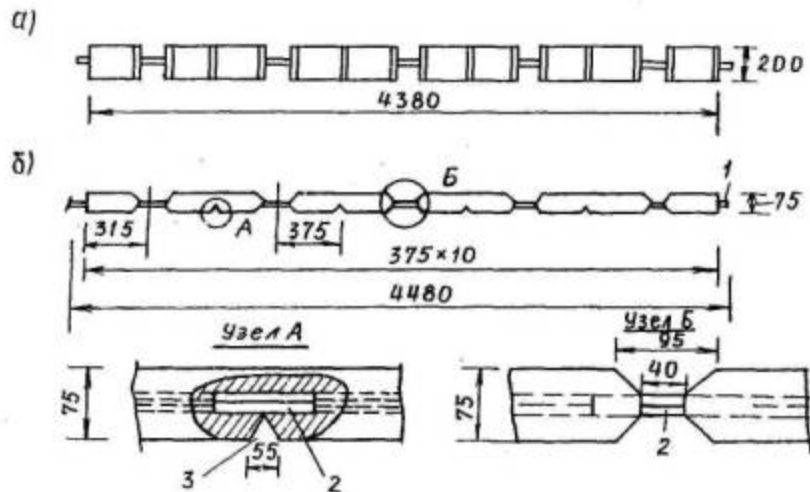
Гирлянды железобетонного решетчатого покрытия:
